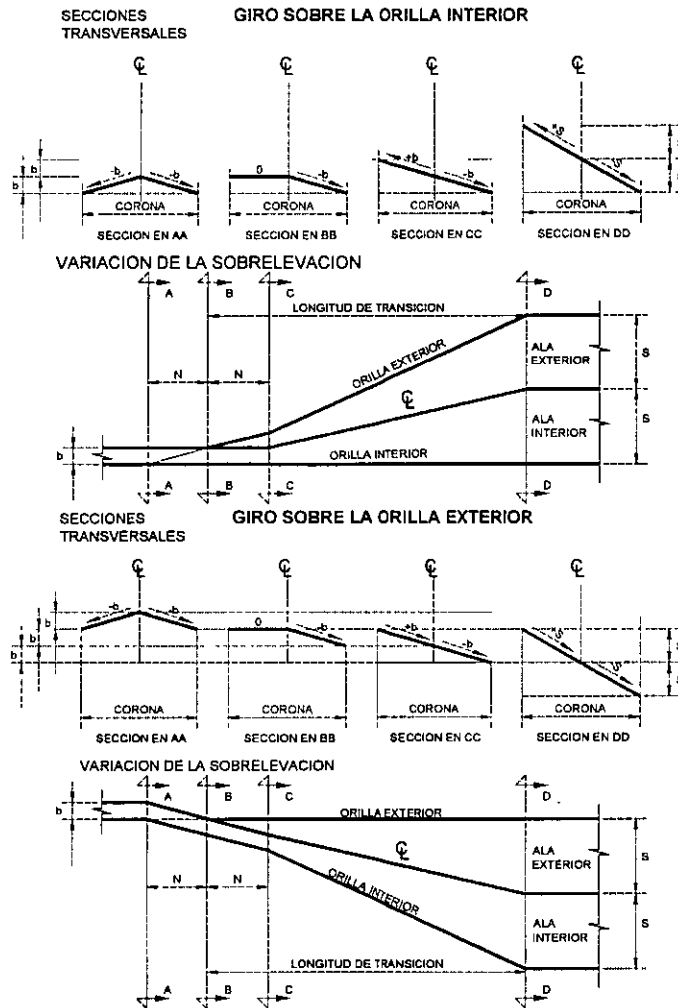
TRANSICIÓN DE LA SECCION TANGENTE A LA SECCIÓN EN CURVA GIRANDO SOBRE UNA ORILLA DE LA CORONA
